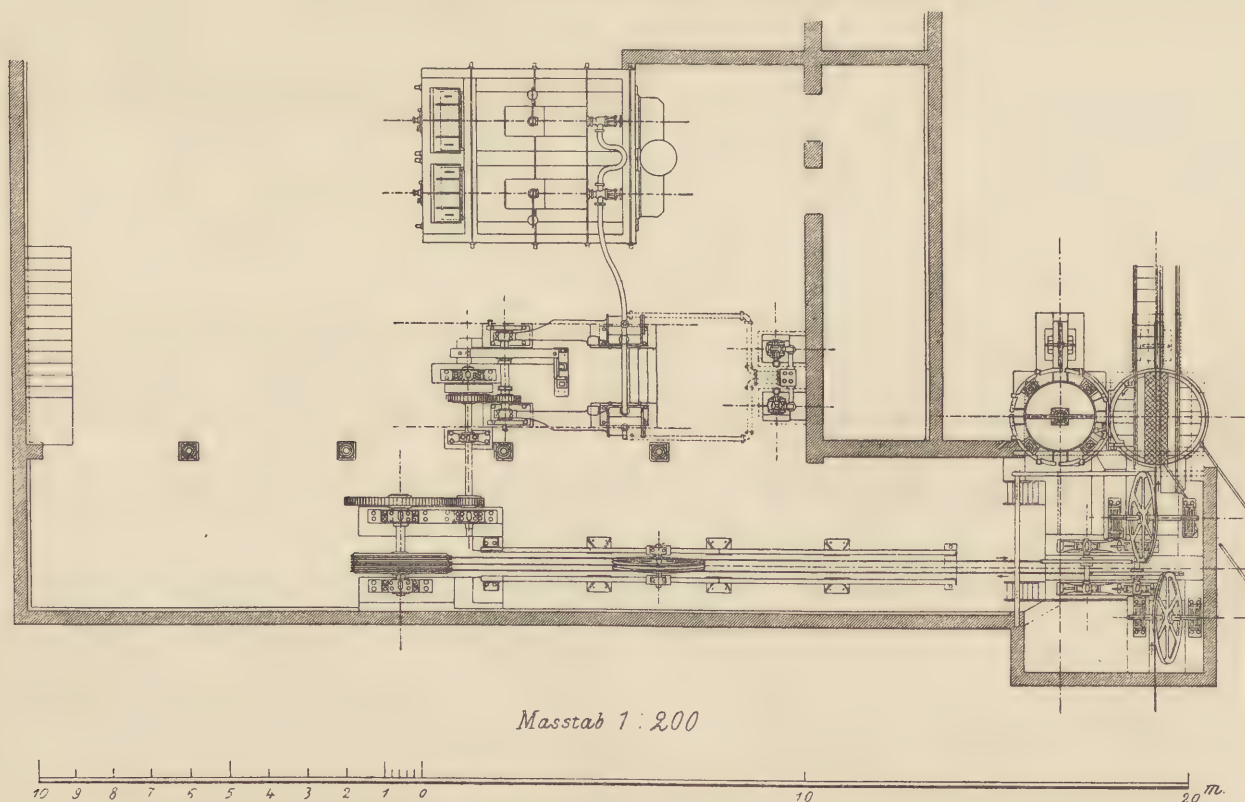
Grundriss des Maschinenraumes in Clay-Street zu San Francisco.
